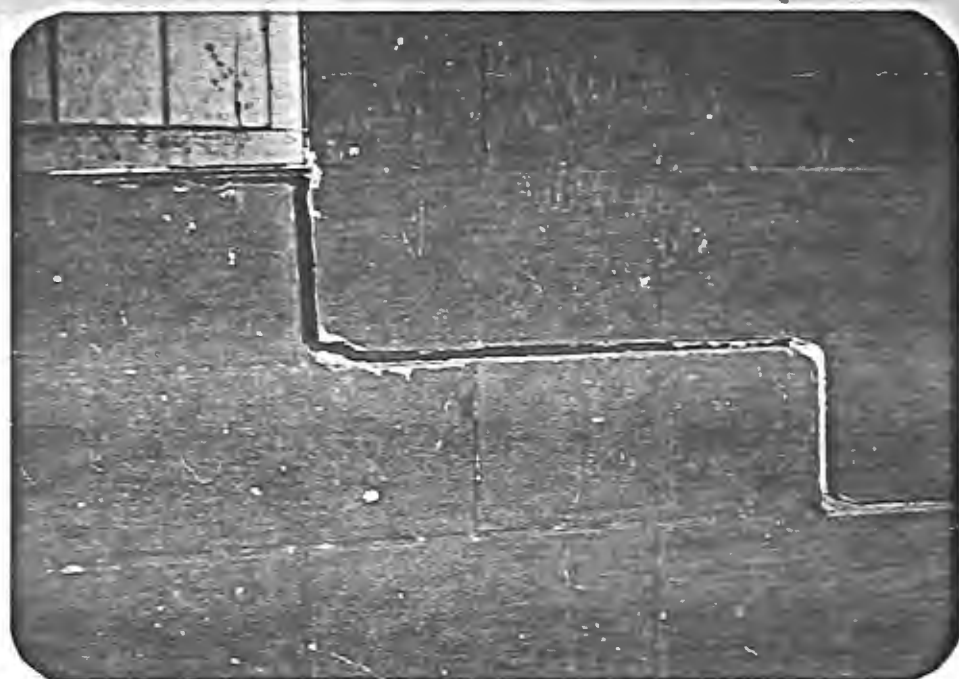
DETALHE DAS RACHADURAS JUNTO ÀS JANELAS.
